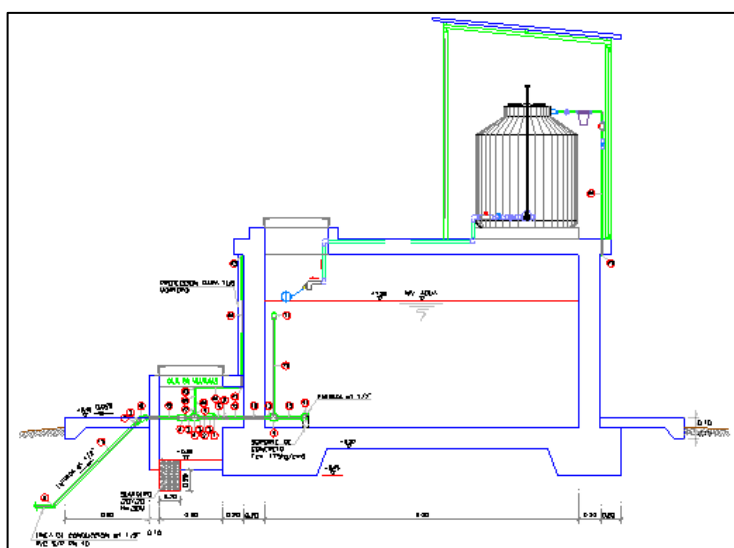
Vista de Elevación del Reservorio Proyectado
